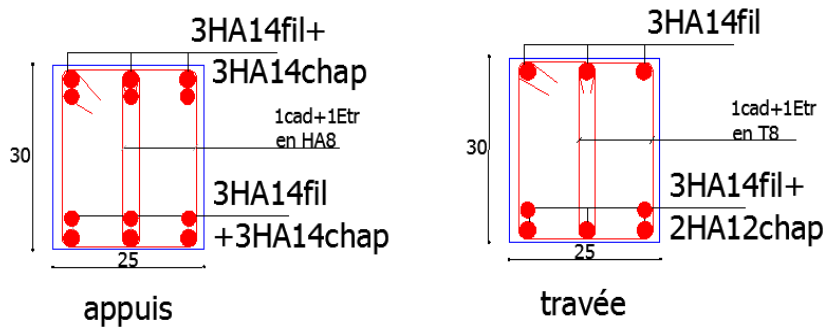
schéma de ferrailage des poutres principale adhérent au voiles
